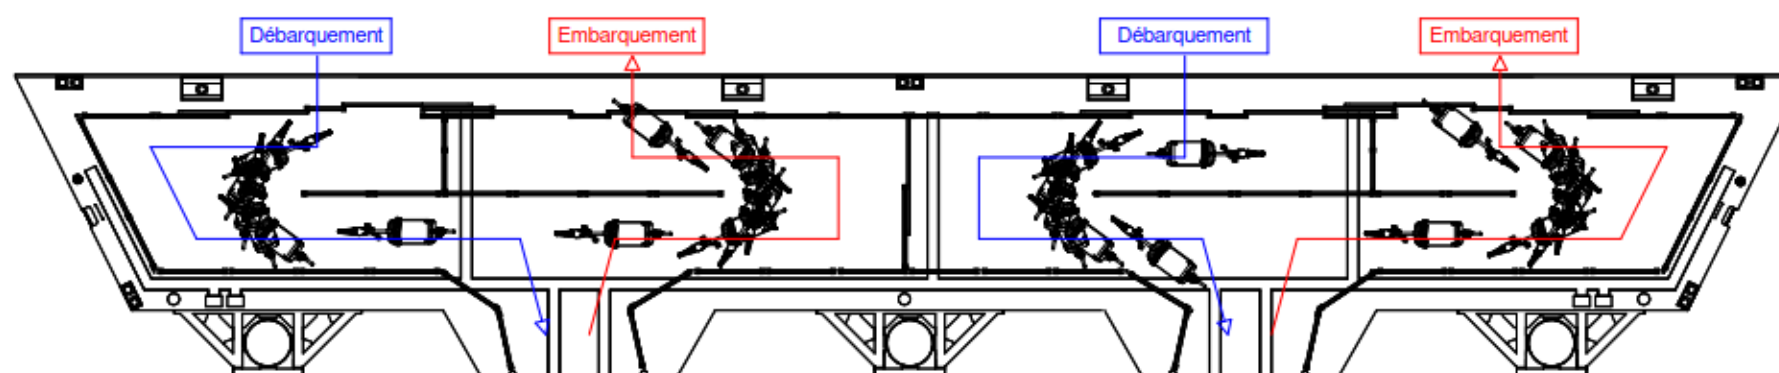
Vue en plan détaillée du ponton (Source : AVP)
